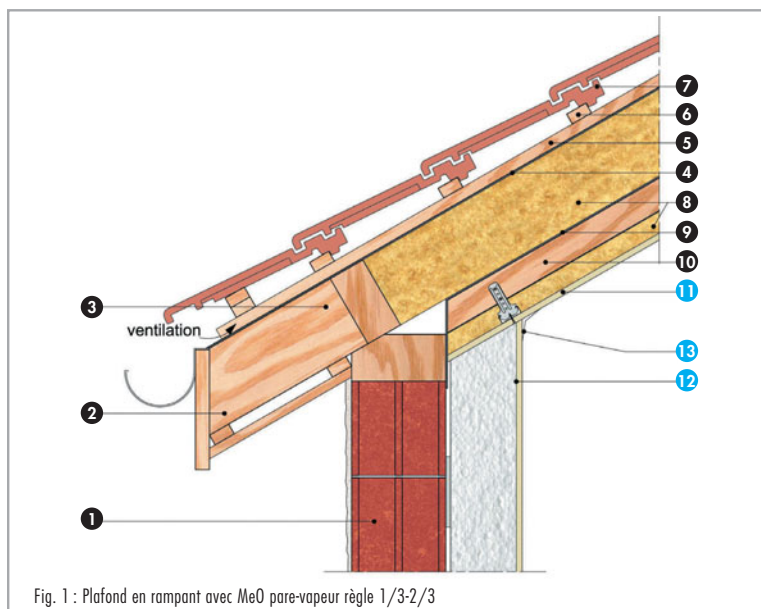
Plafond en rampant avec MeO pare-vapeur règle 1/3-2/3
